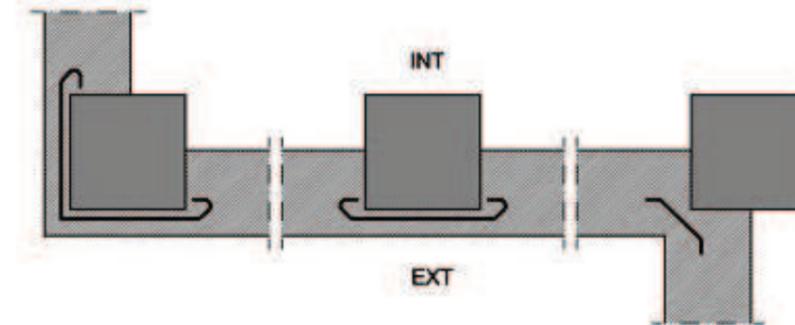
Ejemplo de encuentro de la fachada con los pilares
